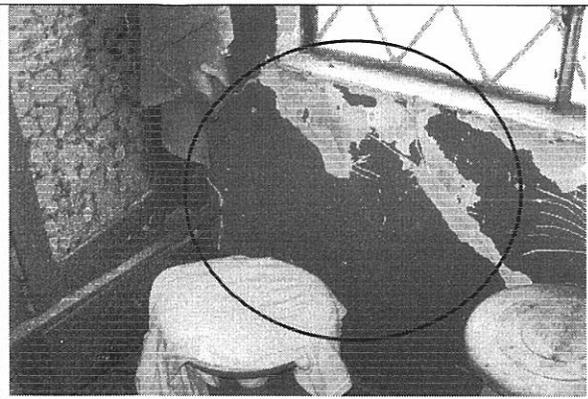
Agrietamiento en muro de la habitación de la zona frontal
